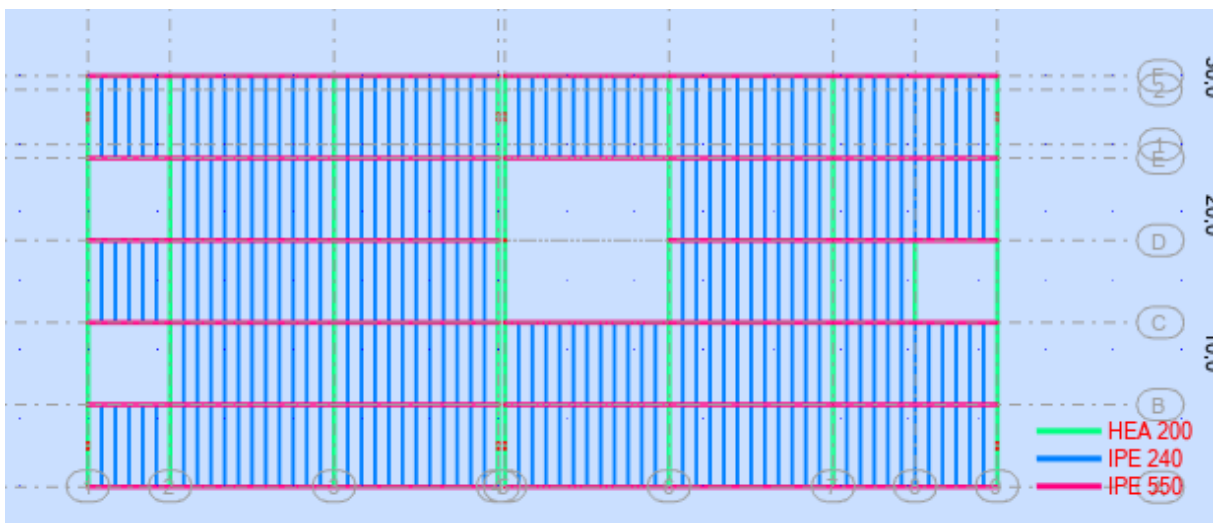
Vue en plan du plancher niveau : 5.10 m
